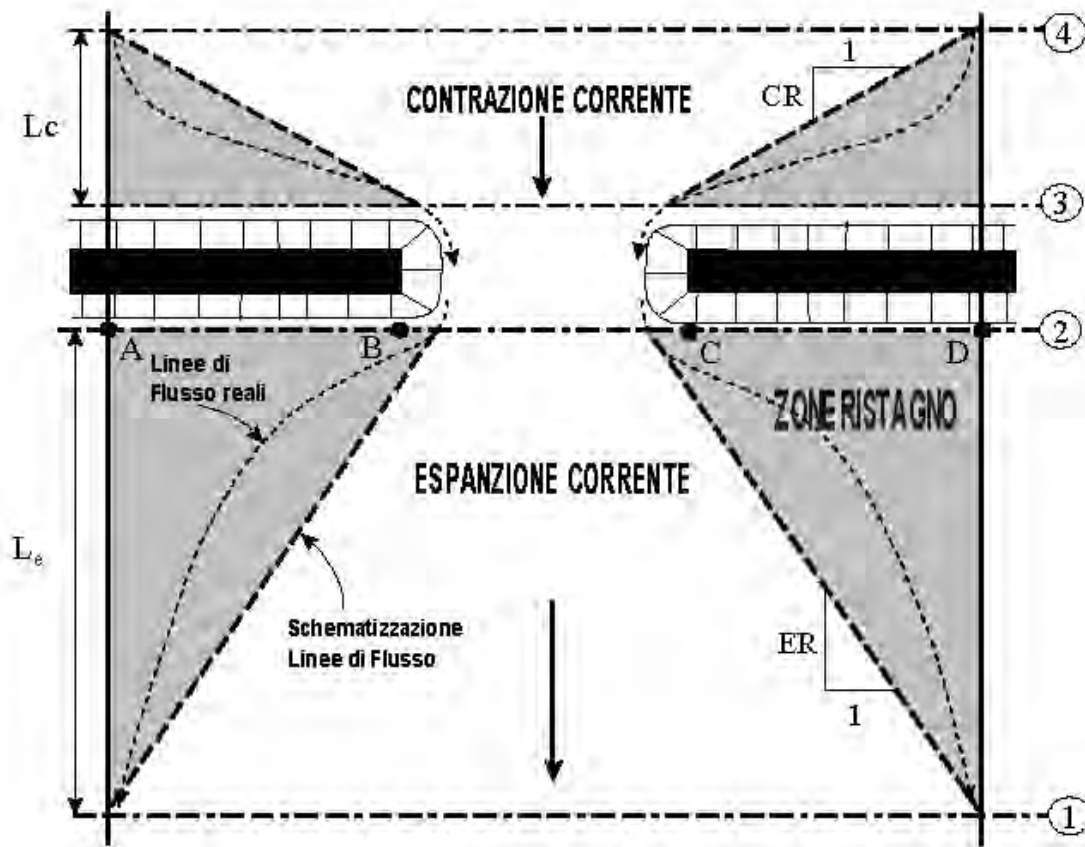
Contrazione ed espansione della corrente per effetto delle spalle dei ponti e conseguente riduzione a monte e a valle, della sezione liquida efficace (introduzione zone di ristagno)
